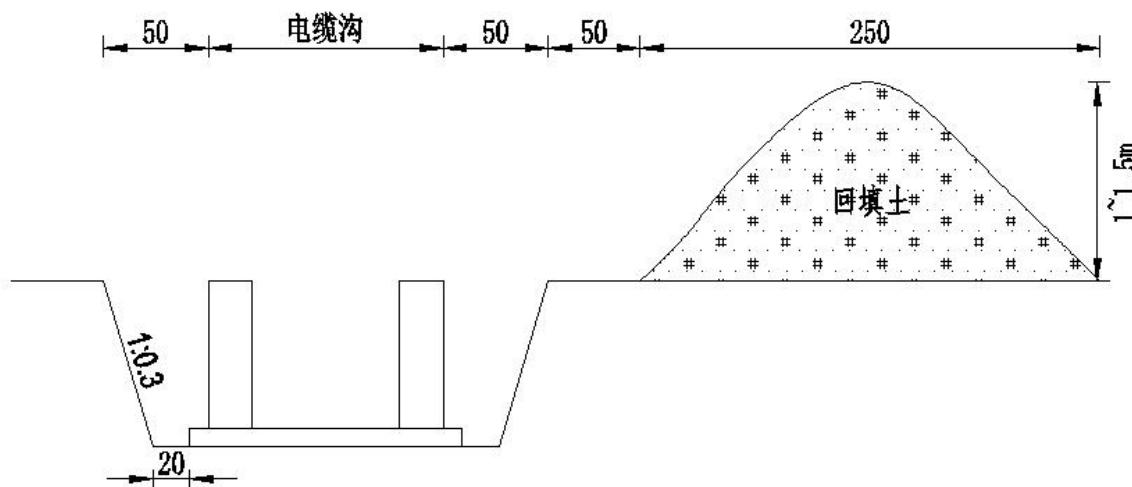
电缆沟敷设施工断面示意图（单位 cm）
